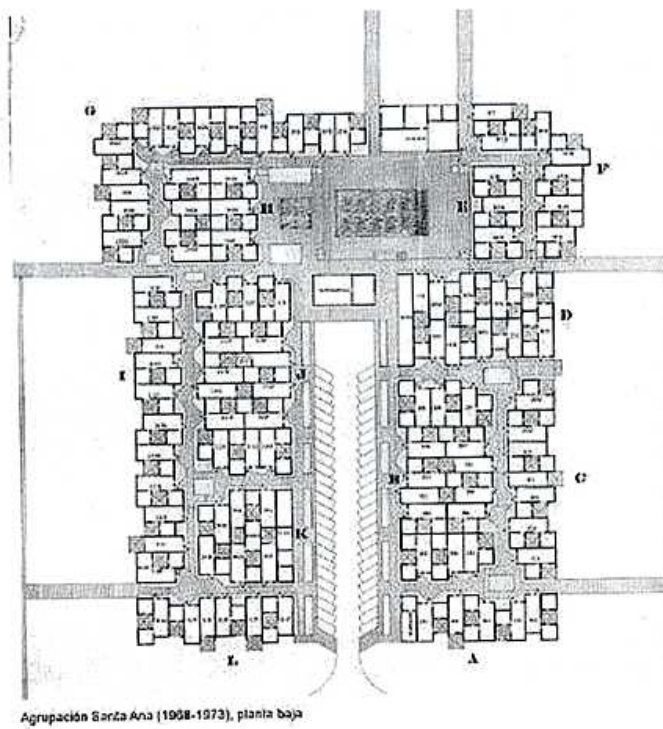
Agrupación Santa Ana*. Ordenación general. Planta baja.
